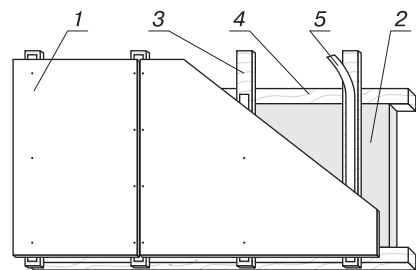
Схема крепления по деревянной обрешетке: 1 — плита; 2 — утеплитель; 3 — доска 32×100 мм; 4 — поперечный брусок (толщина бруска равна толщине утеплителя); 5 — резиновая лента. Шаг крепления плит: на вертикальных швах — 300 мм, на горизонтальных — 600 мм, шаг обрешетки — 600 мм. При монтаже без утеплителя поперечные бруски не используются
